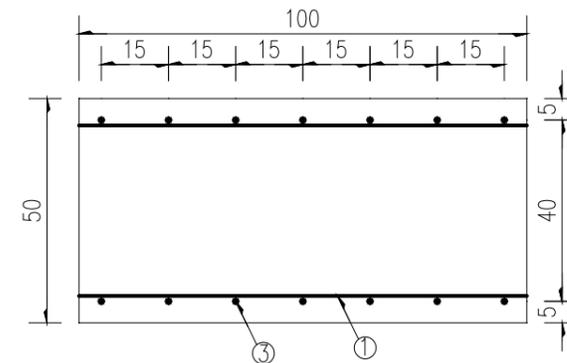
护栏断面 3-3 计算简图（尺寸单位：cm）
